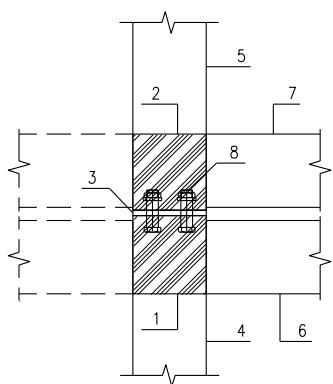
建筑底部模块单元与下部混凝土结构连接示意
